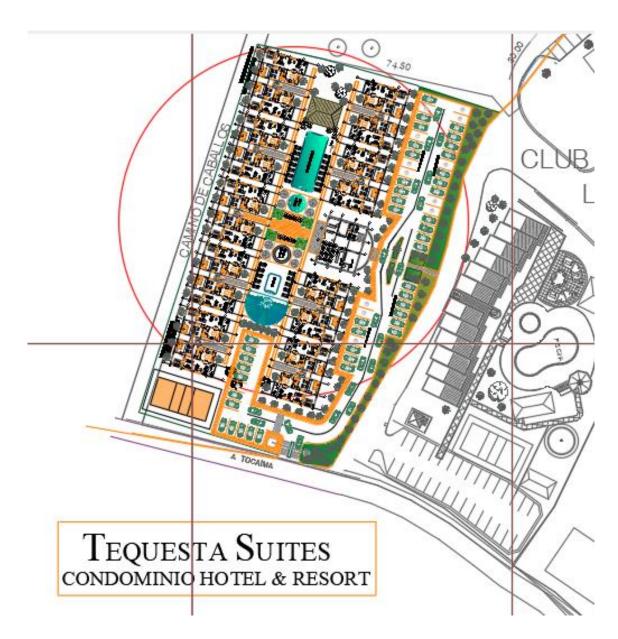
Ubicación Hotel Tequesta Suites. Fuente: Autores del Proyecto
